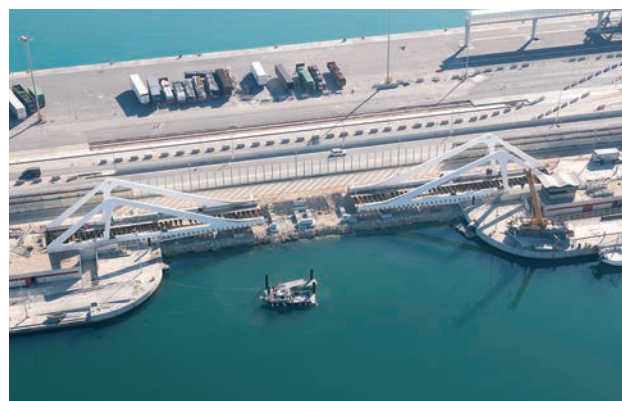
y 30. Cortes en estructura metálica del puente basculante.
